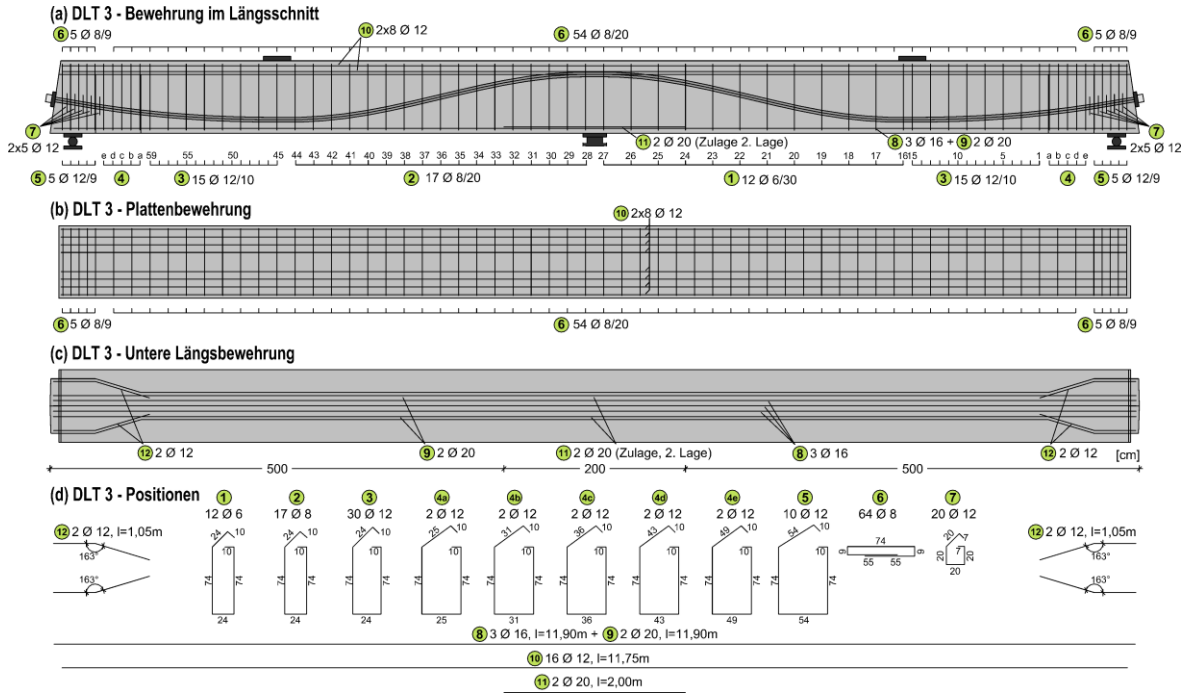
Bewehrungsplan Versuchsträger DLT 3
